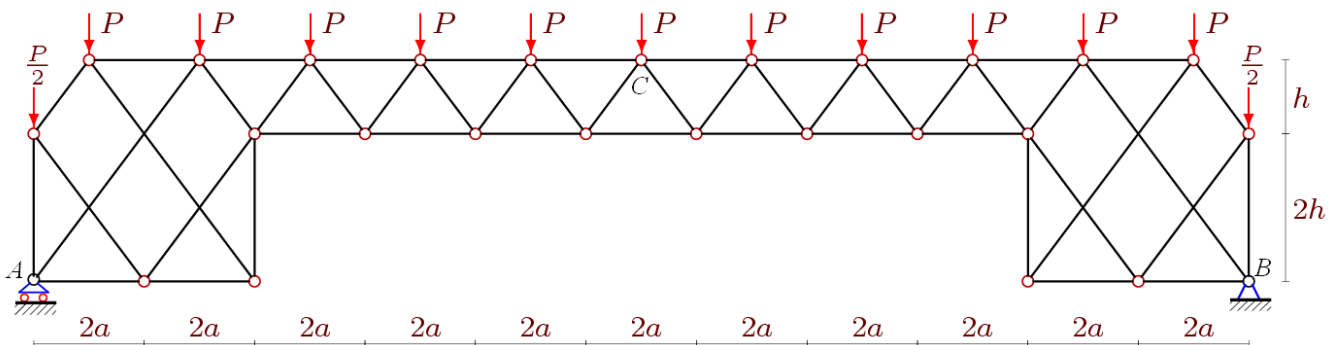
Нагрузка на верхний пояс фермы, $n=6$
